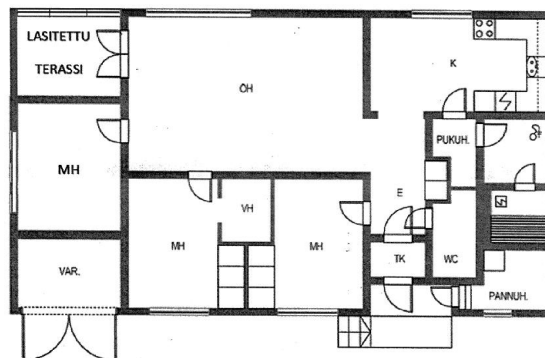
Hochwertiger Grundrissplan aus dem CubiCasa5k Datensatz. Plan beinhaltet wenige Details, wodurch es überschaubarer wird. Name: CC5K-631
